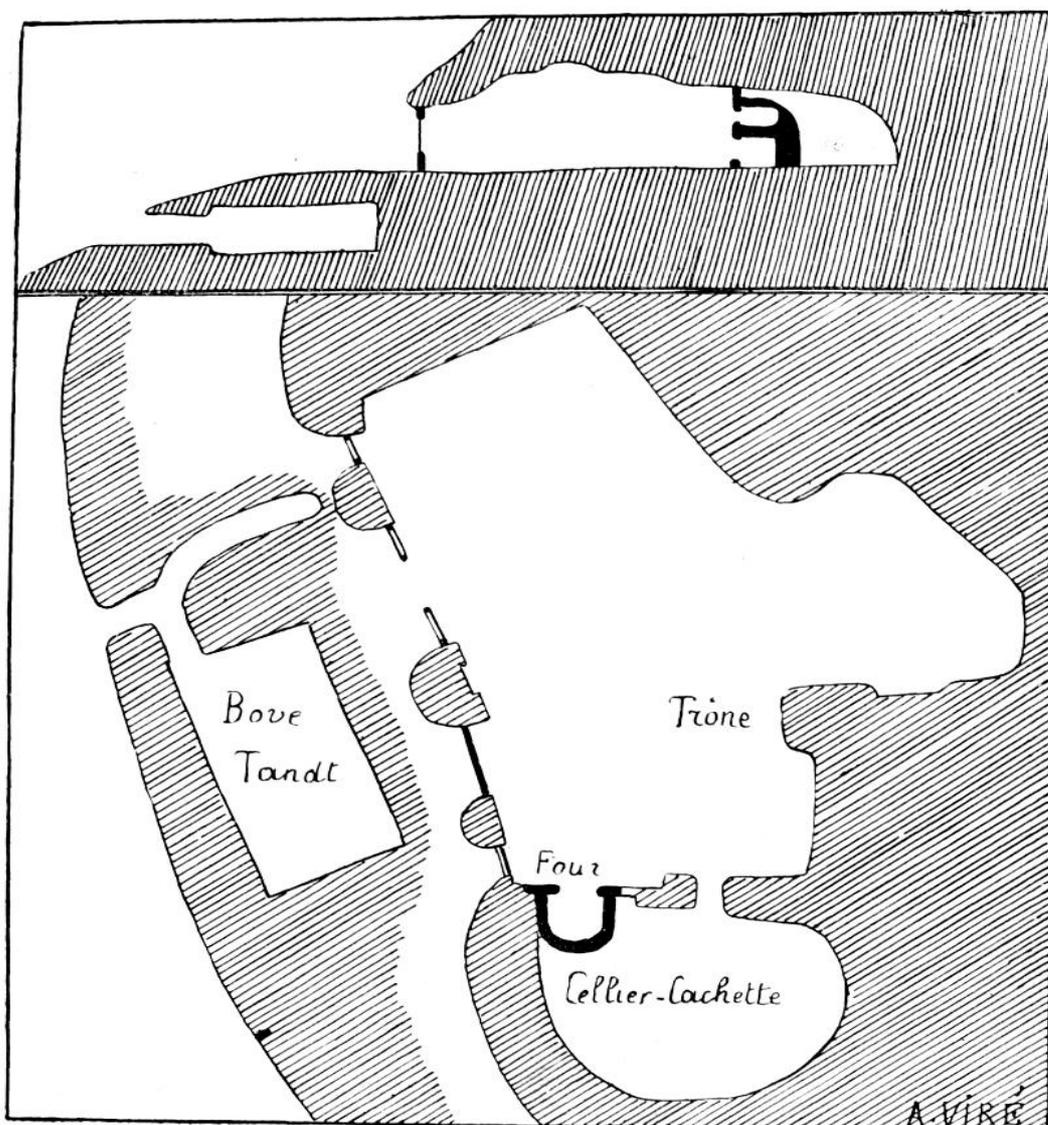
Plan et coupe de la Salle du Chef Normand et de la Bove Thandt.
